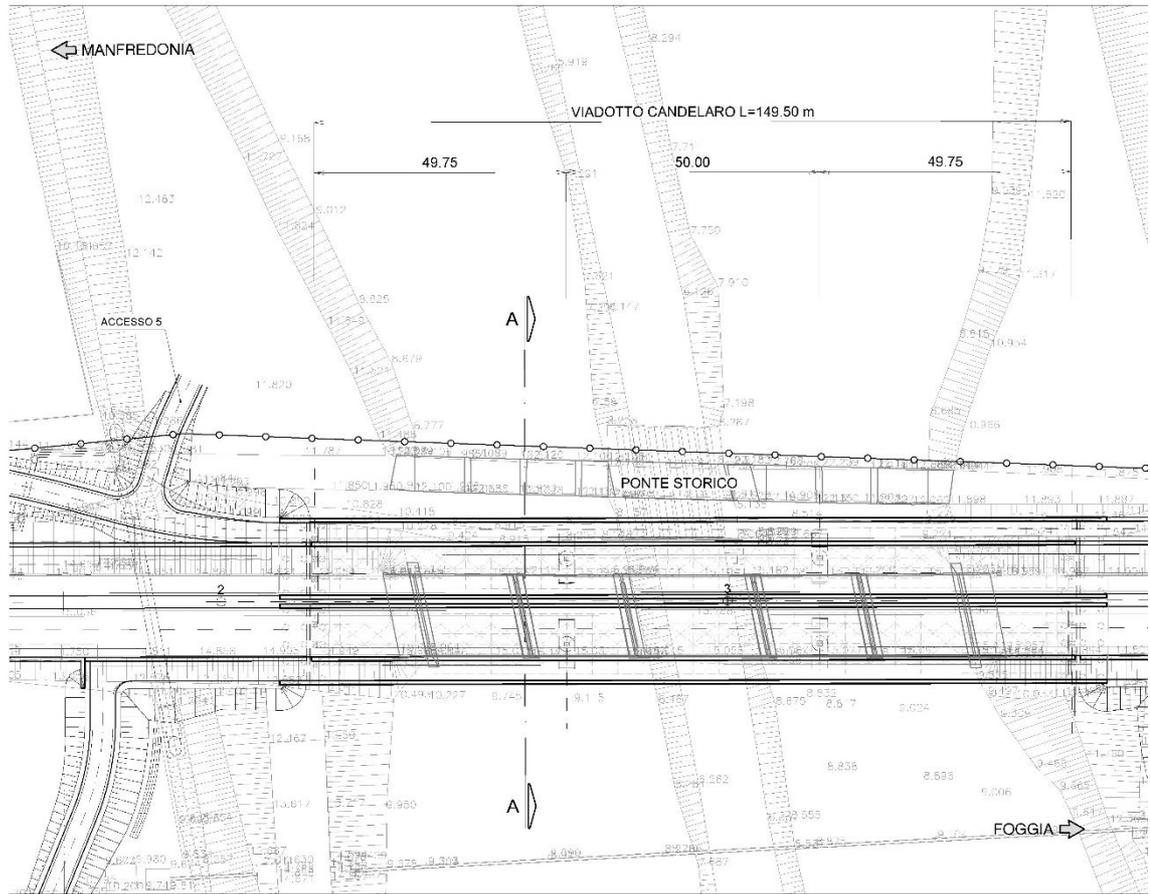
Viadotto Candelaro PD 2020 – Stralcio planimetrico
